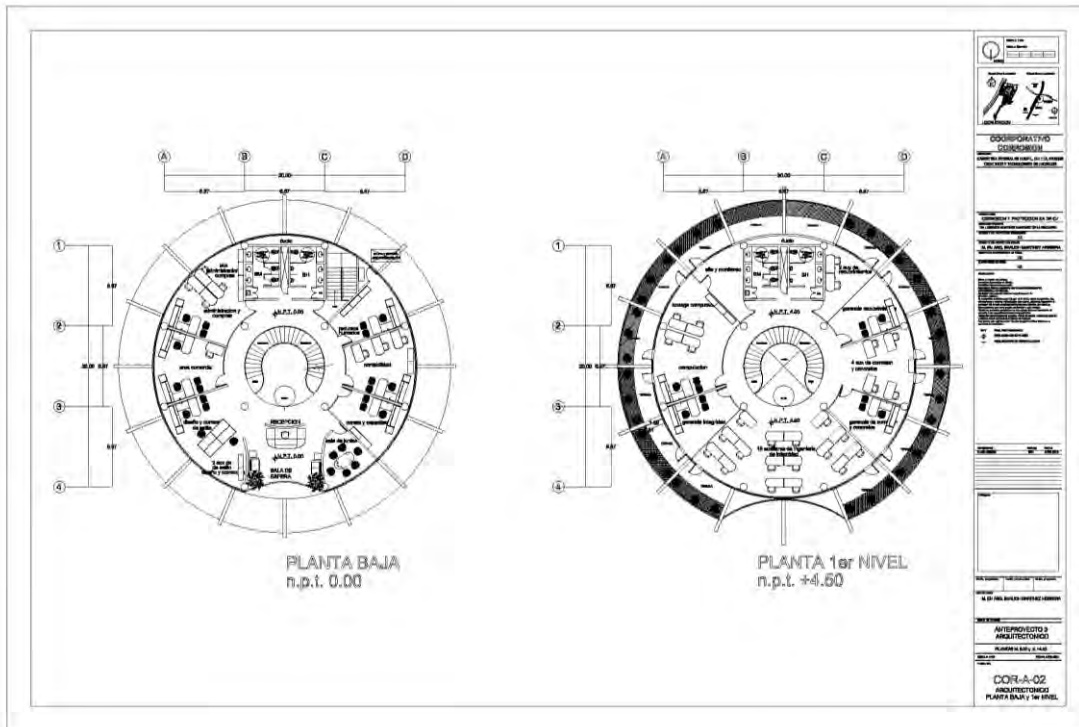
Plano arquitectónico planta baja y primer nivel, fuente Baruch Martínez.
